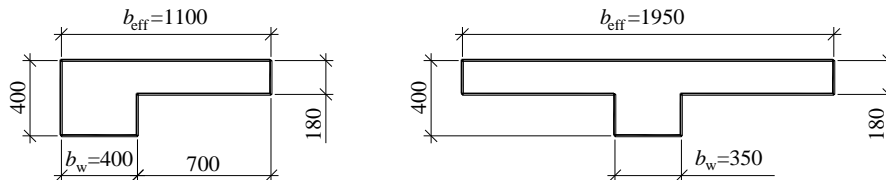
Поперечные сечения и габаритные размеры балок (с учетом эффективной ширины плит перекрытий) в расчетной схеме здания:
